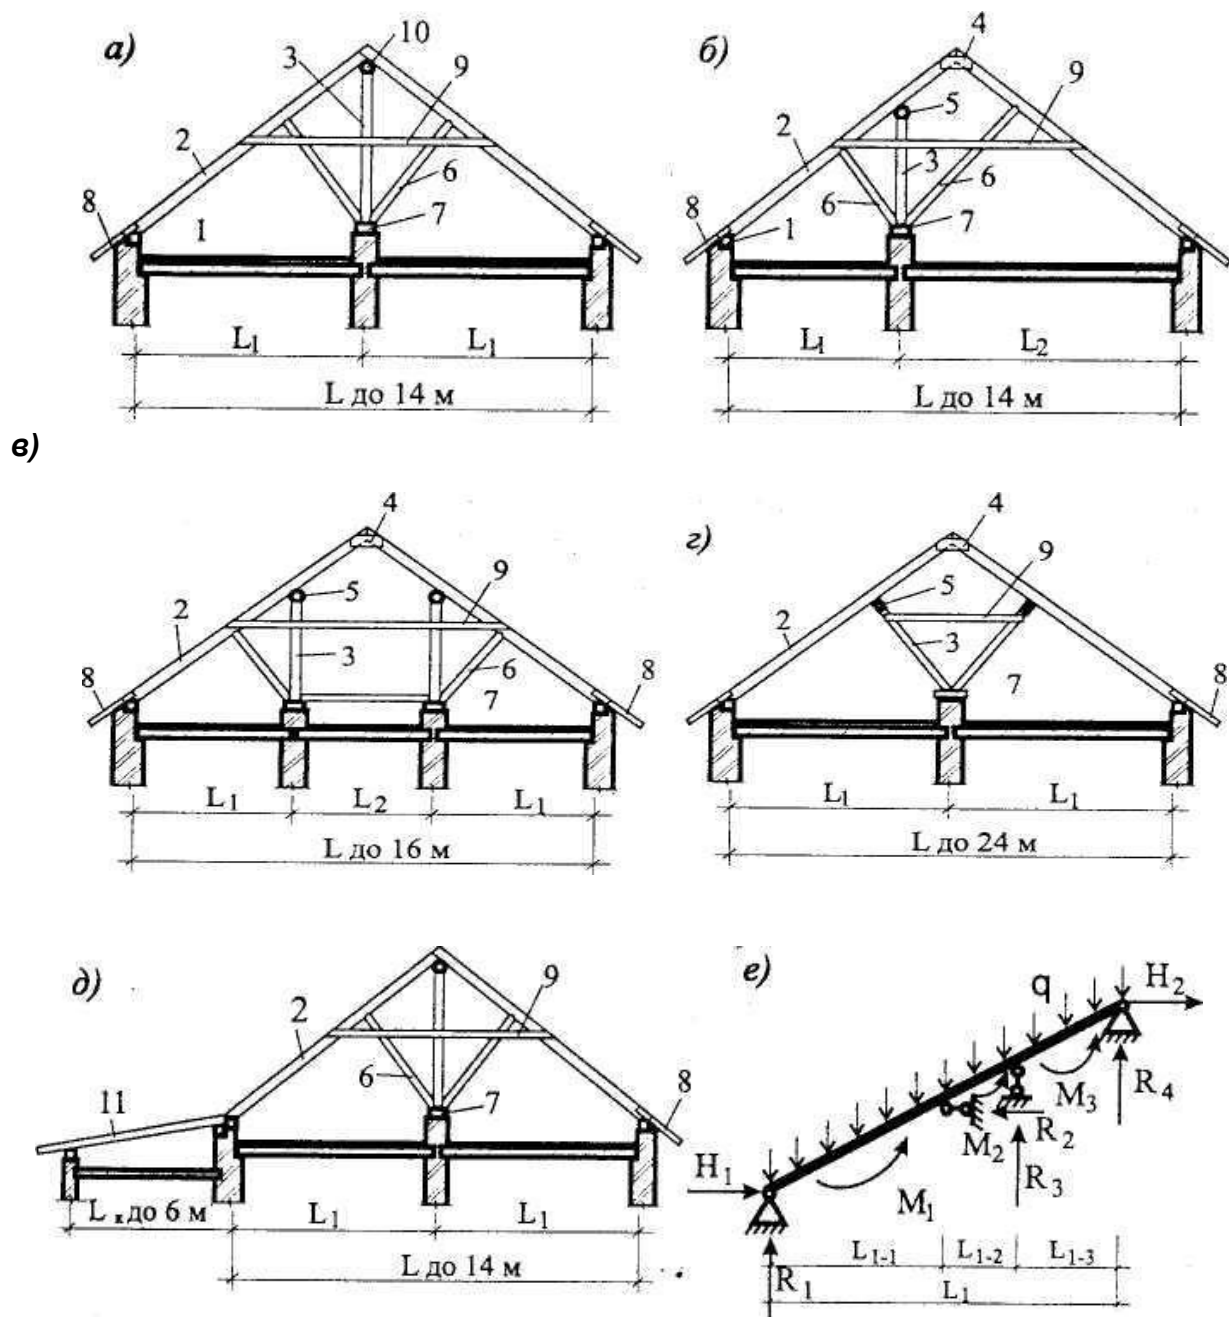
Схемы несущих конструкций двускатных деревянных крыш с наслонными стропилами:
